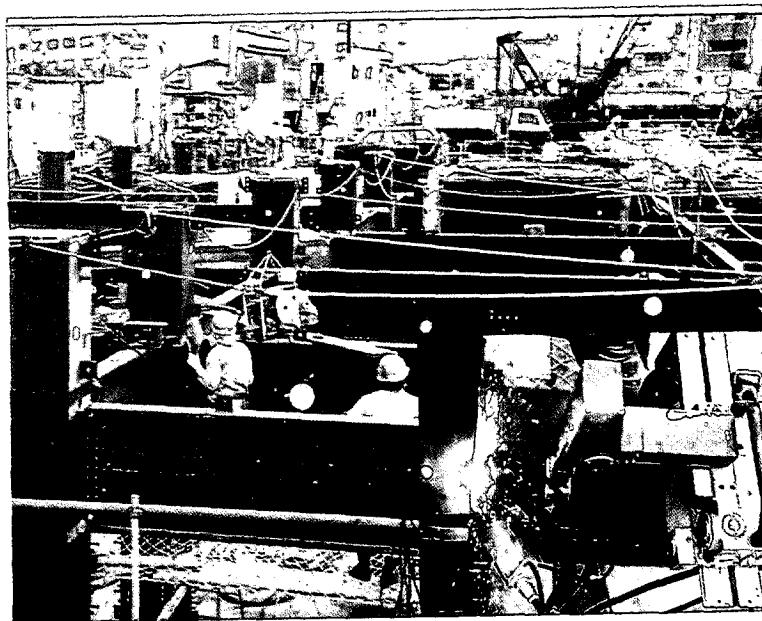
Robot soldador (Fujita Corp., Japón)
